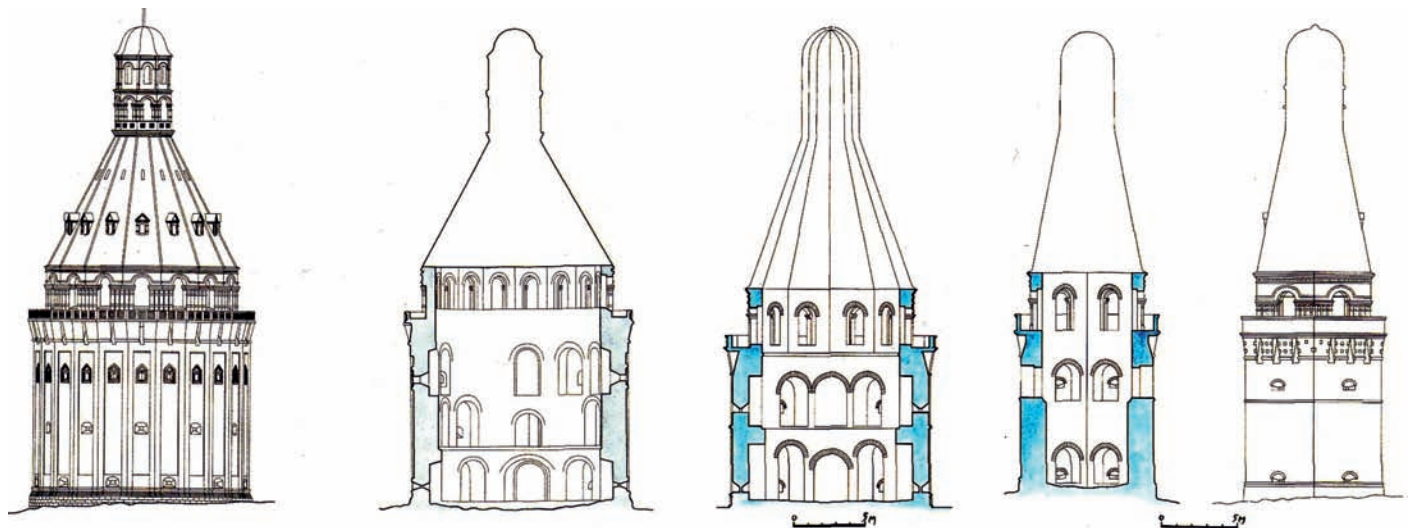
Фасады и профили башен Дуло, Солевой и Кузнечной [17, с.191]
